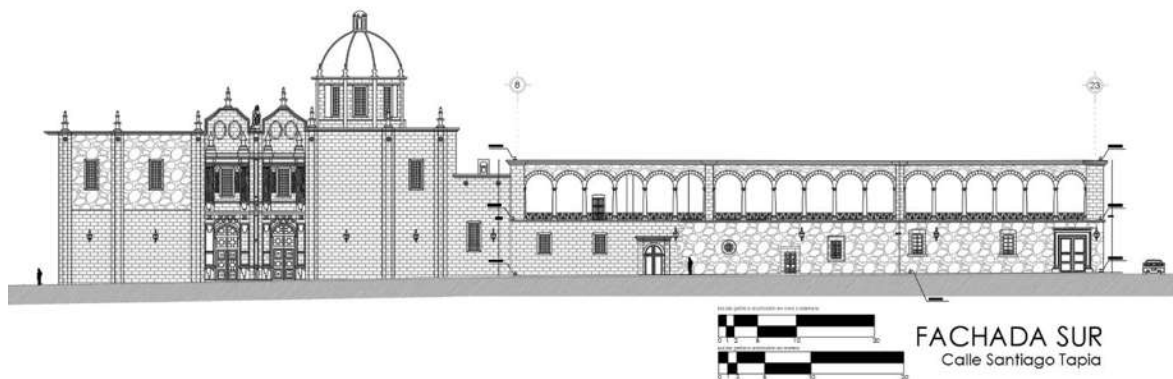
Fachada principal del conjunto arquitectónico de las Rosas.
